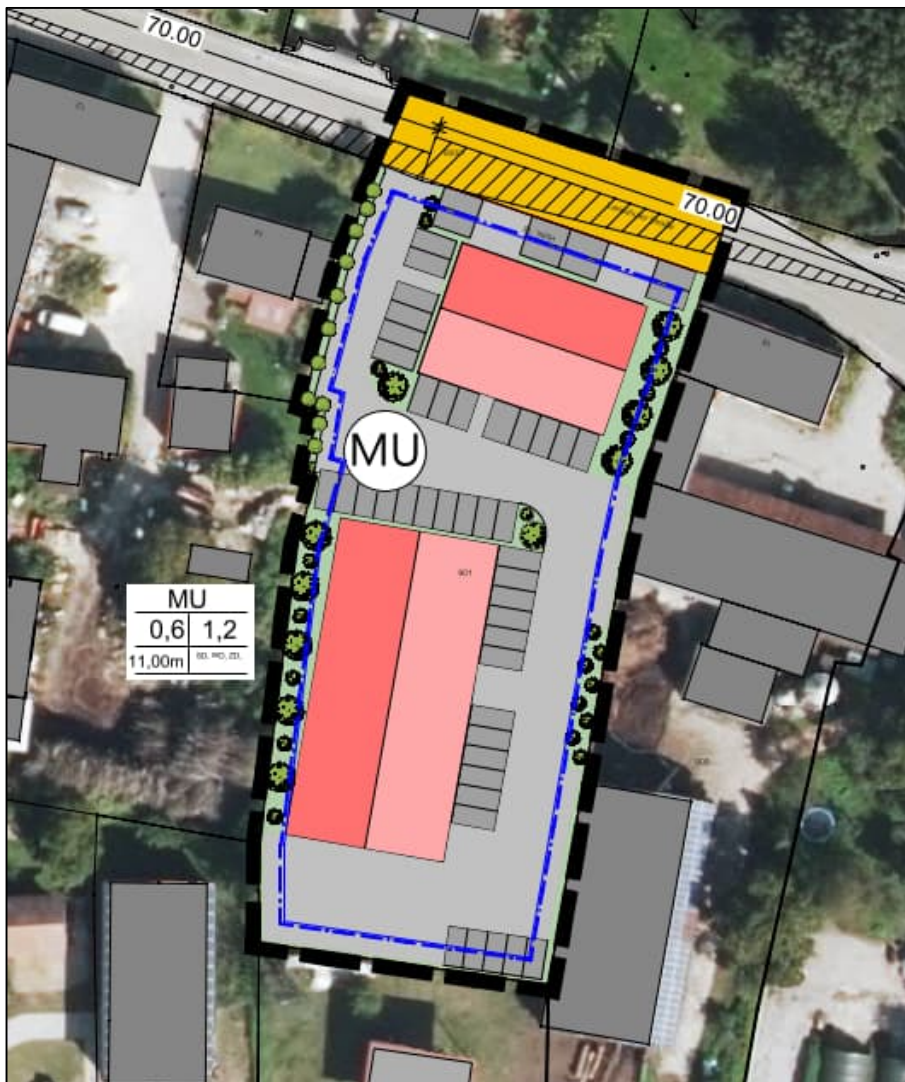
Planzeichnung zum Bebauungsplan "MU Landshuter Straße" des Markts Siegenburg /20/
